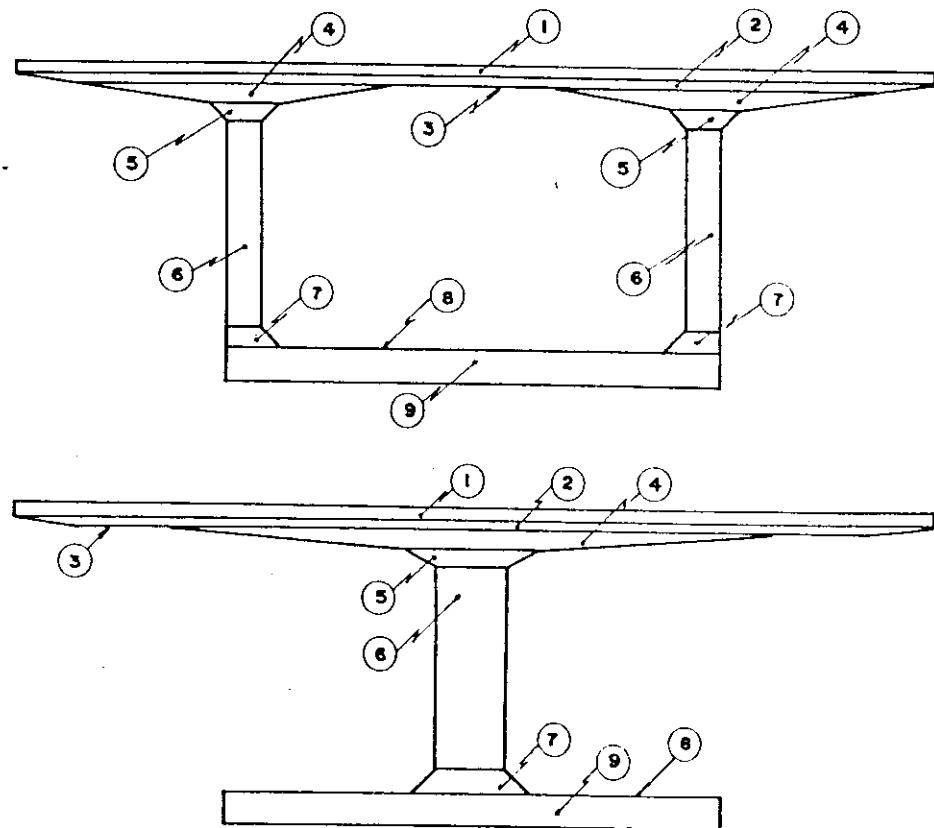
DIVISÃO DA SEÇÃO TRANSVERSAL EM TRAPEZIO
